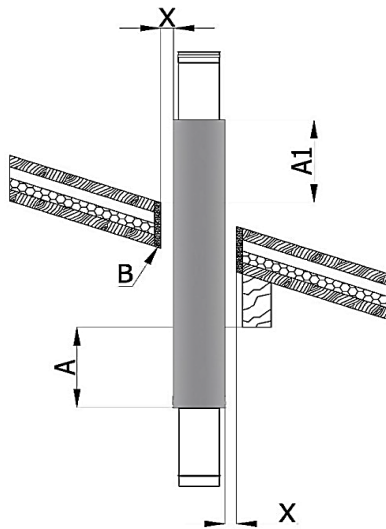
Attraversamento a tetto ventilato con travetto trasversale
